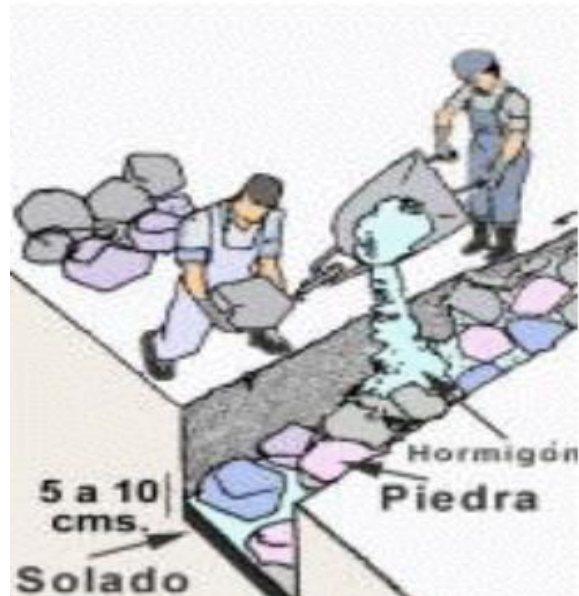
Colocación de un hormigón de tipo ciclópeo.
